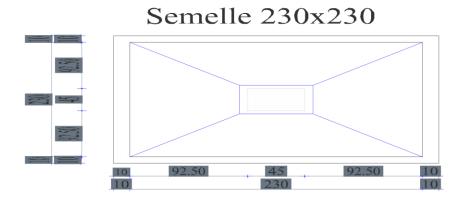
schéma de ferraillage semelle isolée sous poteau
